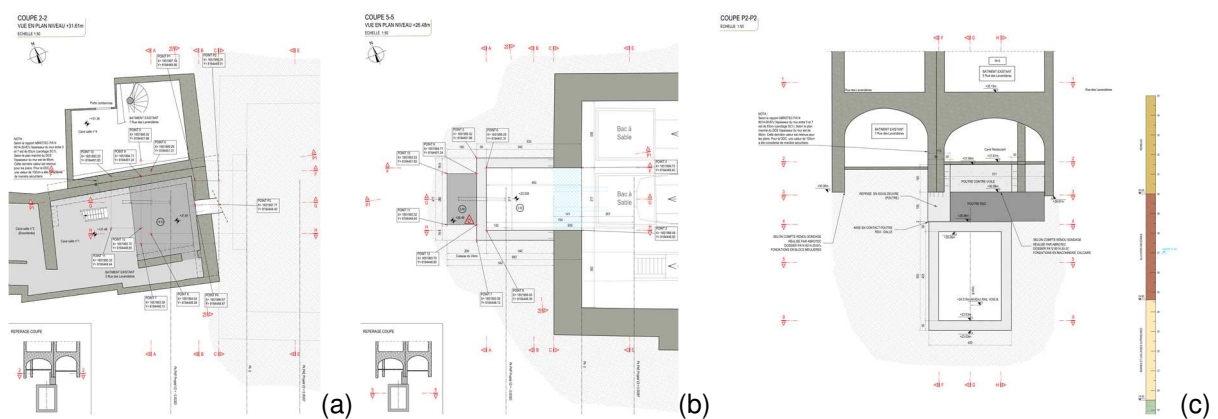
(a) Vue en plan niveau caves (b) vue en plan niveau niche (c) coupe transversale
